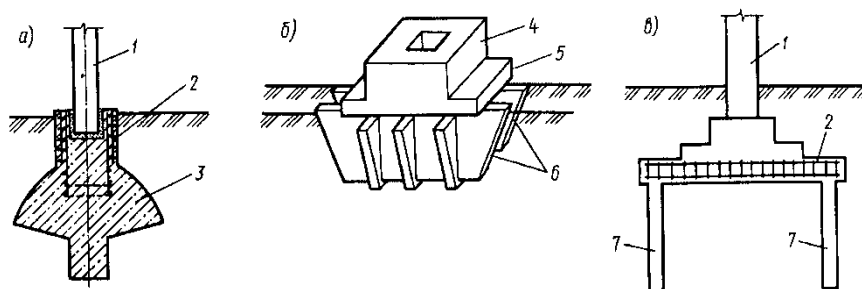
Буробетонные (а), щелевые (б) и анкерные (в) фундаменты:
